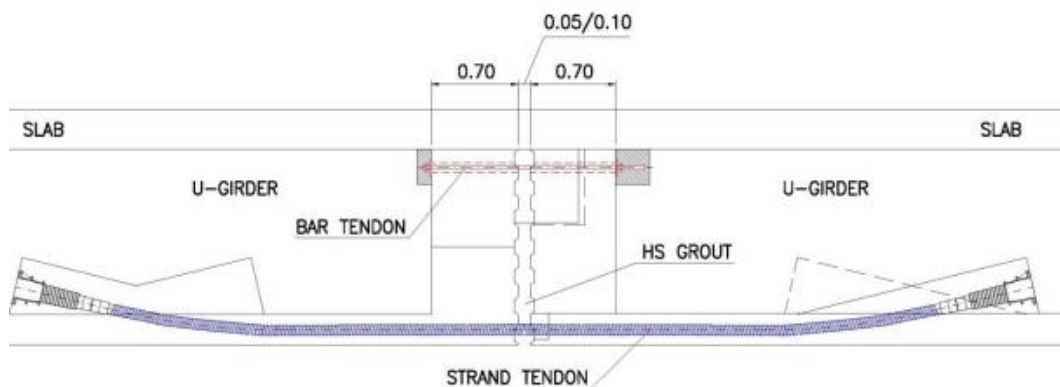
Exemplos de ligações viga-viga para a garantia de continuidade estrutural.
